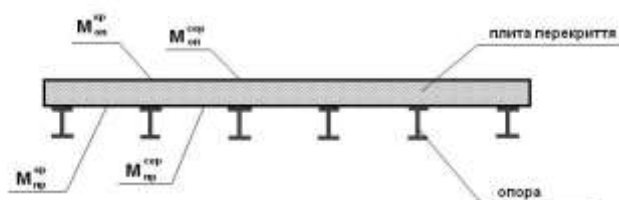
Схема згинальних моментів у багатопротітній залізобетонній плиті перекриття балкону
